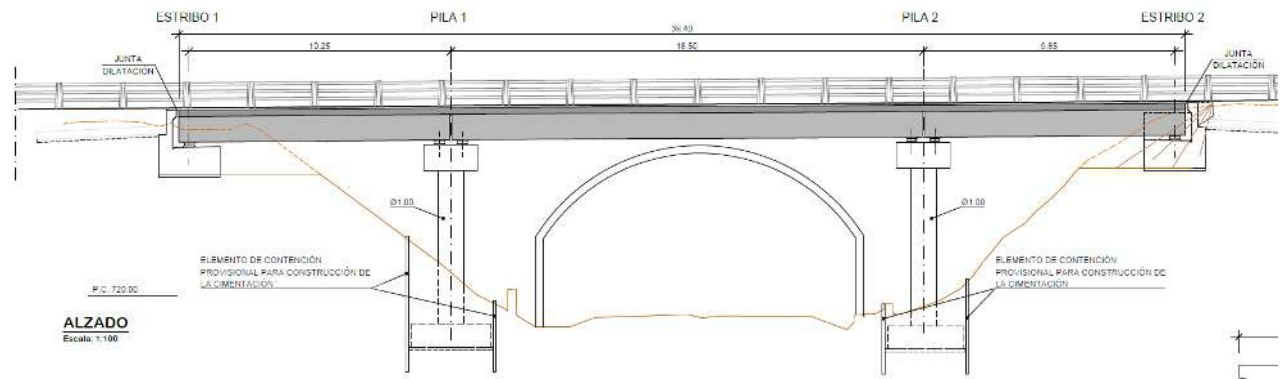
Sección longitudinal. Estructura E-5. Alternativas 1A, 1B y 3A
